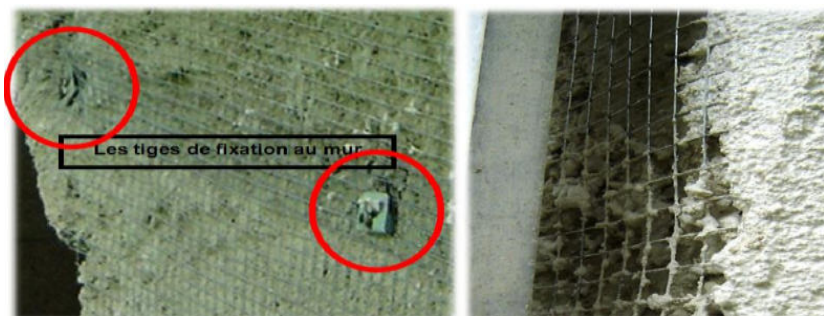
Les étapes du ravalement sur éléments de façade existants.
